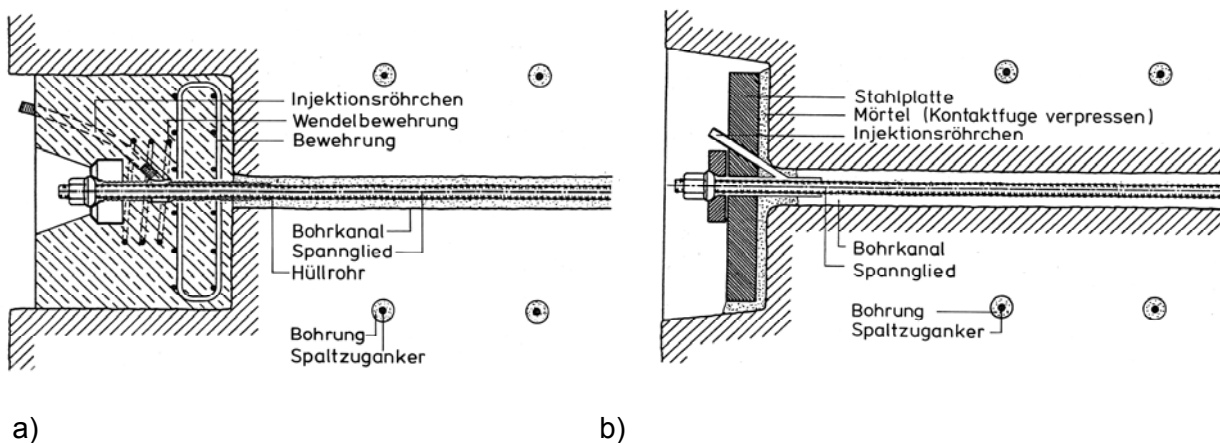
a) Ankerkörper aus Stahlbeton b) Ankerkörper aus Baustahl [Ha.1], [Gu. 2]
